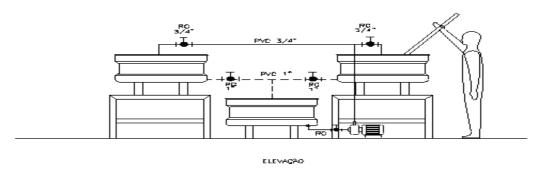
Planta elevada de mini centrais de reciclagem de lâmpadas fluorescentes.
